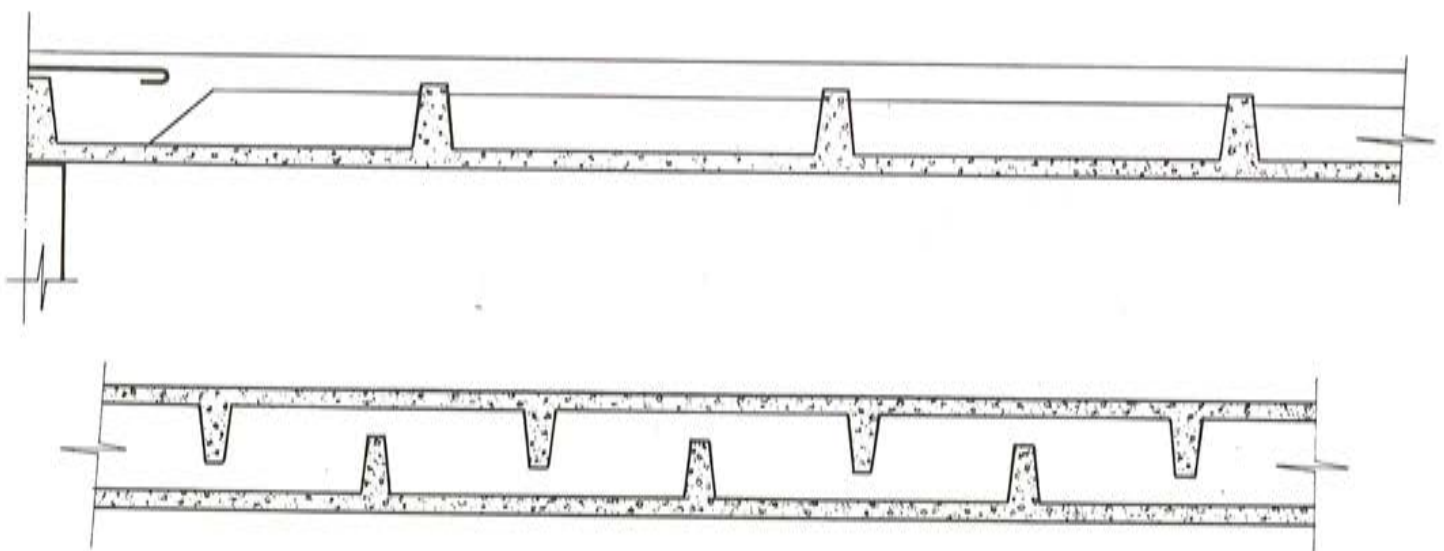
Placas nervadas de ferrocemento para construcción prefabricada.
